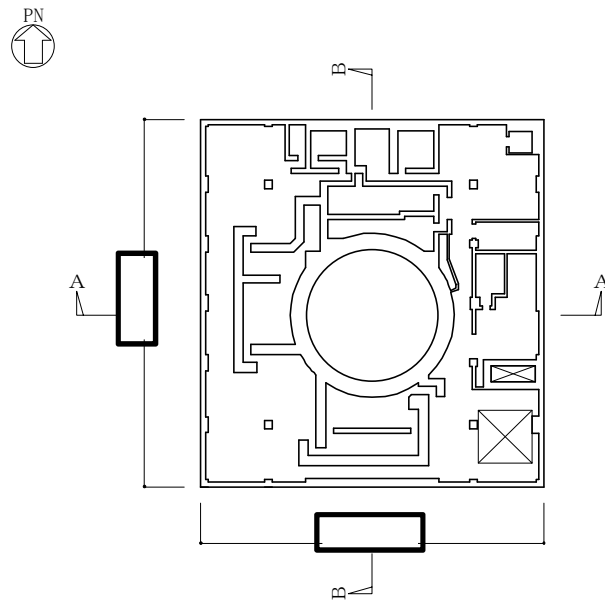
(6/10) 原子炉建屋の概略平面図 (EL. 29.0 m)
